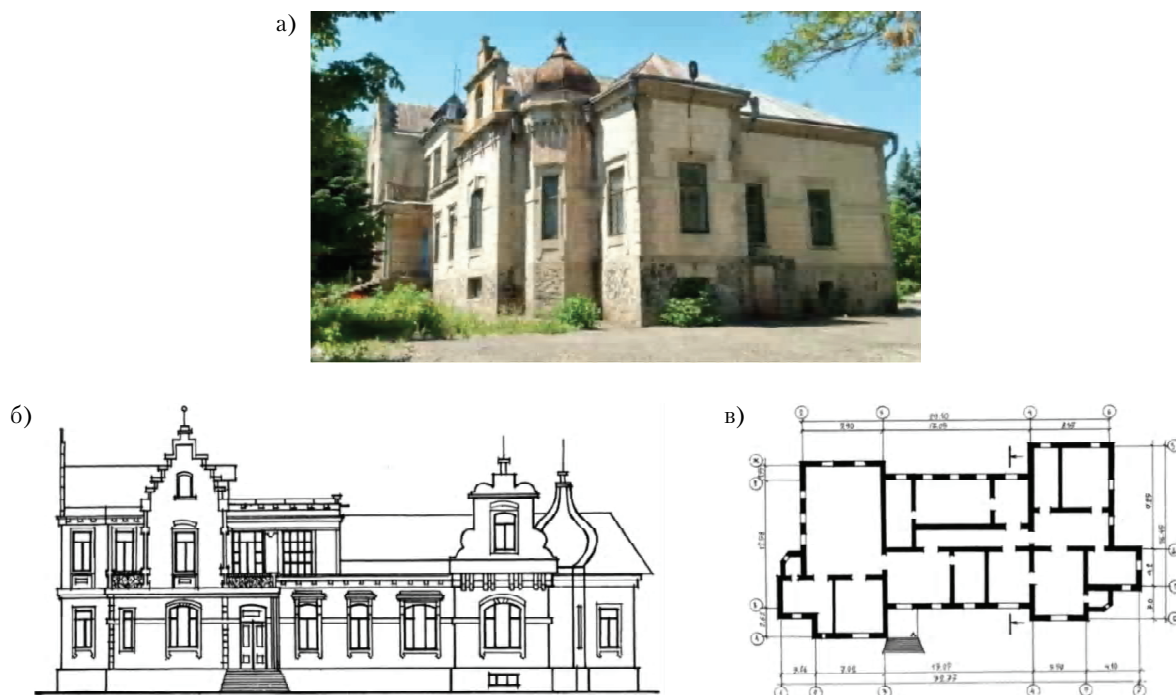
Усадьба помещика С. Г. Роговского в с. Веровка: а) общий вид дома; б) фасад дома; в) план 1-го этажа дома.
